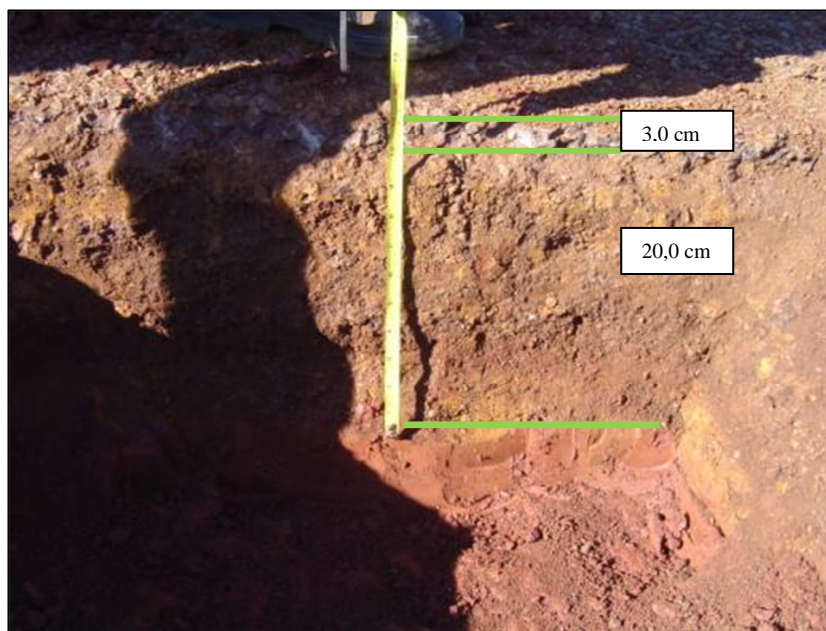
Estrutura do pavimento na Estaca 8+460 LD
